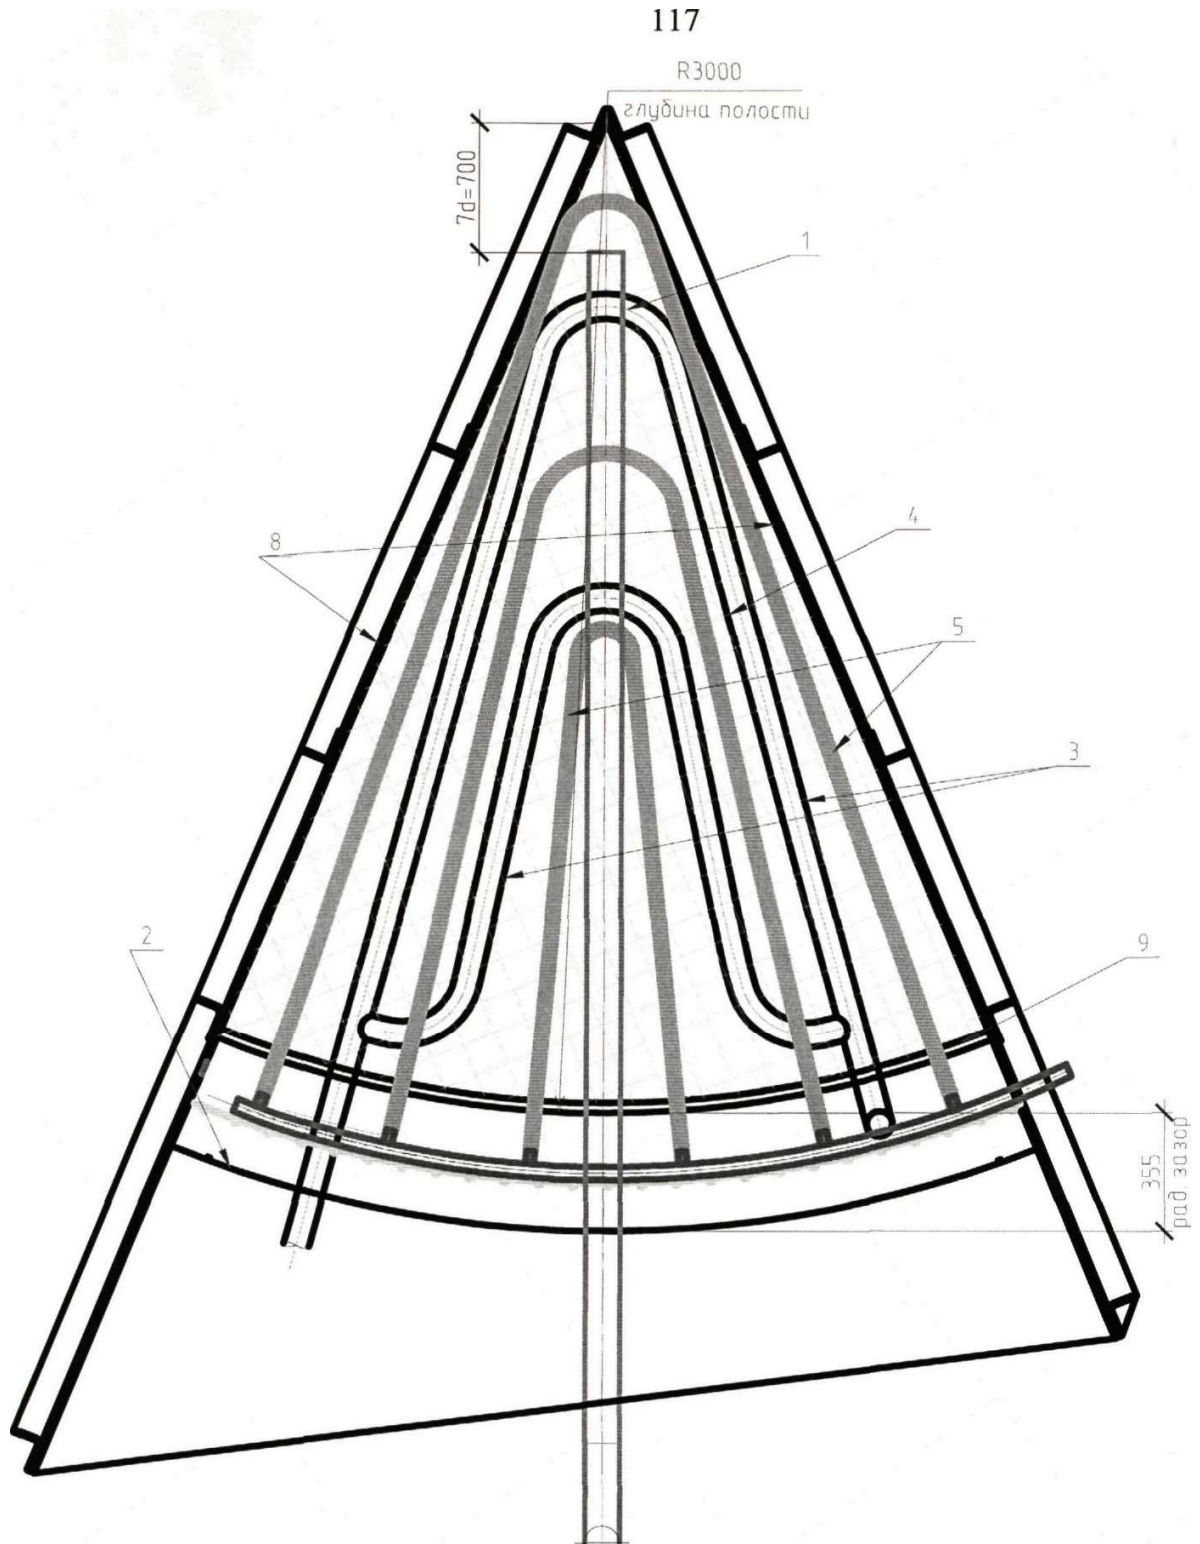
Схема порожнини (вид зверху): 1 - бетоновод; 2 - кільцева знімна опалубка; 3 - трубопроводи; 4 арматурна сітка; 5 - гнучкі гофровані трубки; 6 - нижня металева плита; 8-бічна опалубка; 9-оболонка
